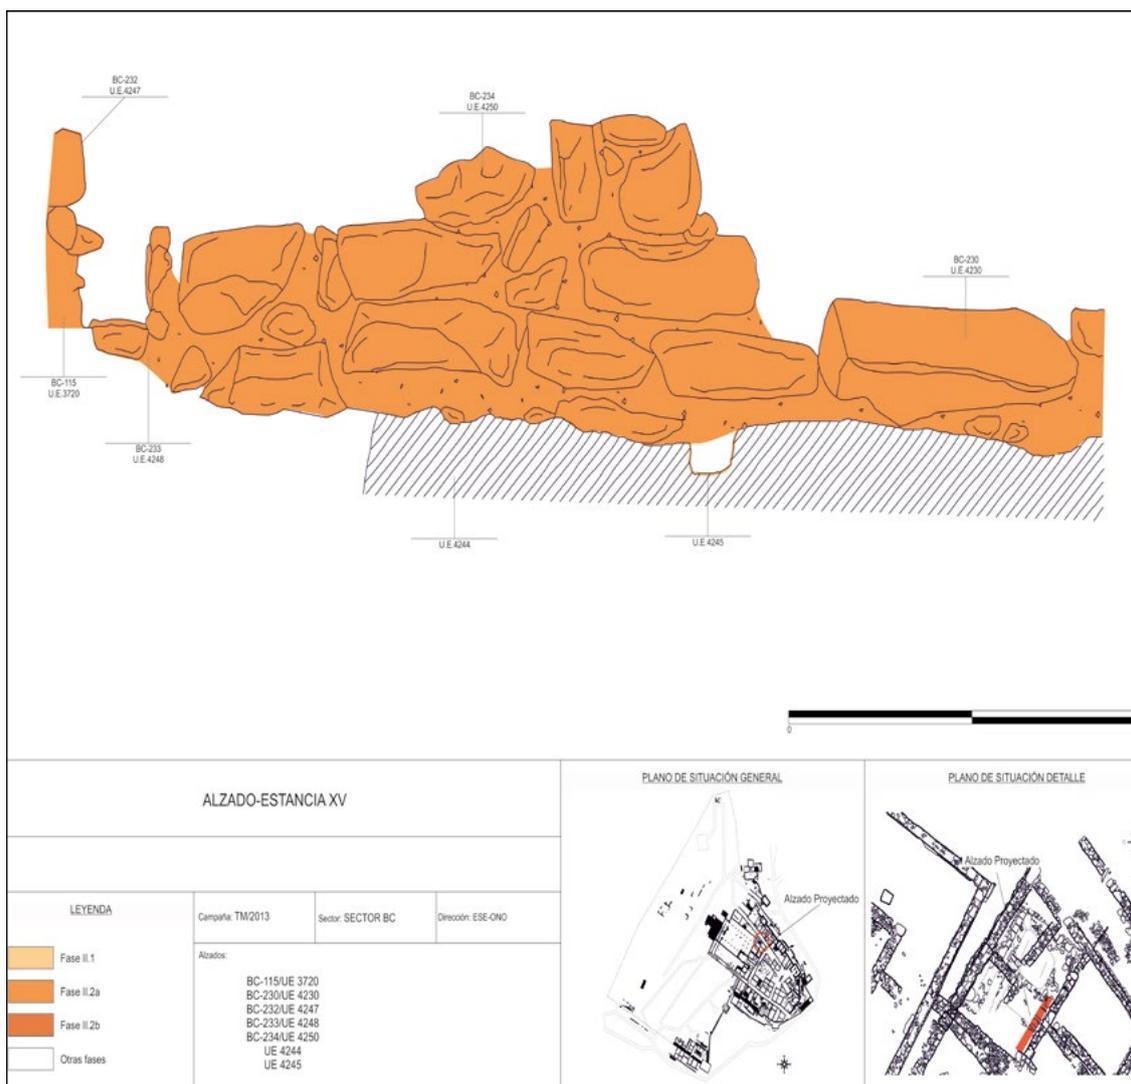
Alzado ESE de la Estancia XV en el que se aprecia una huella de poste horadando la roca y el zócalo y alzado de mampostería. En la vertiente izquierda se observa la presencia en sección del canal del aliviadero de la cisterna helenística III. ATM.
